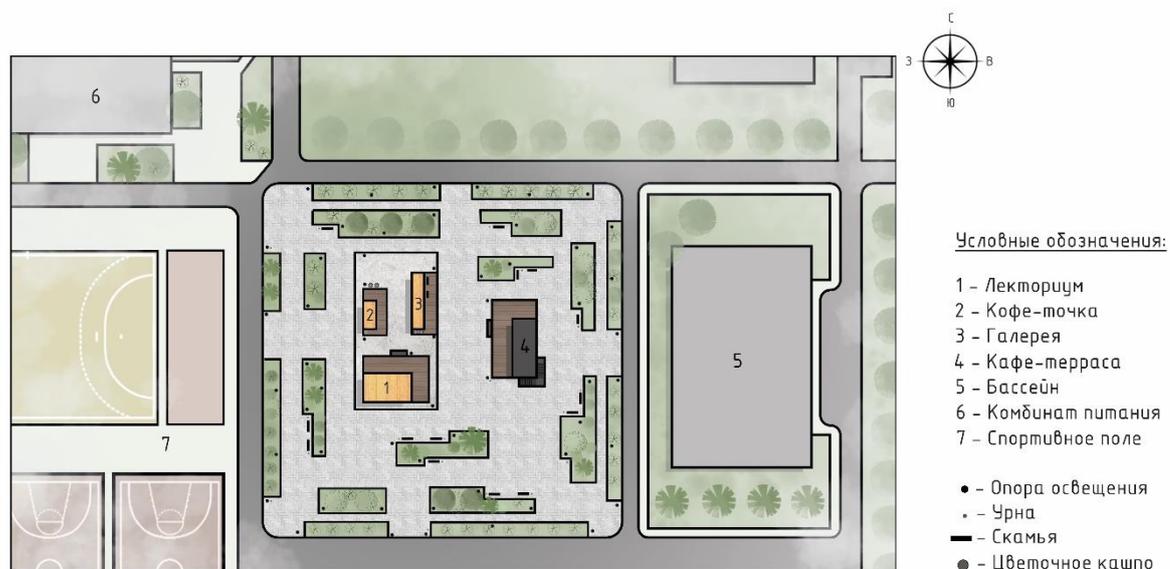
Генеральный план фрагмента территории «Площадка»
